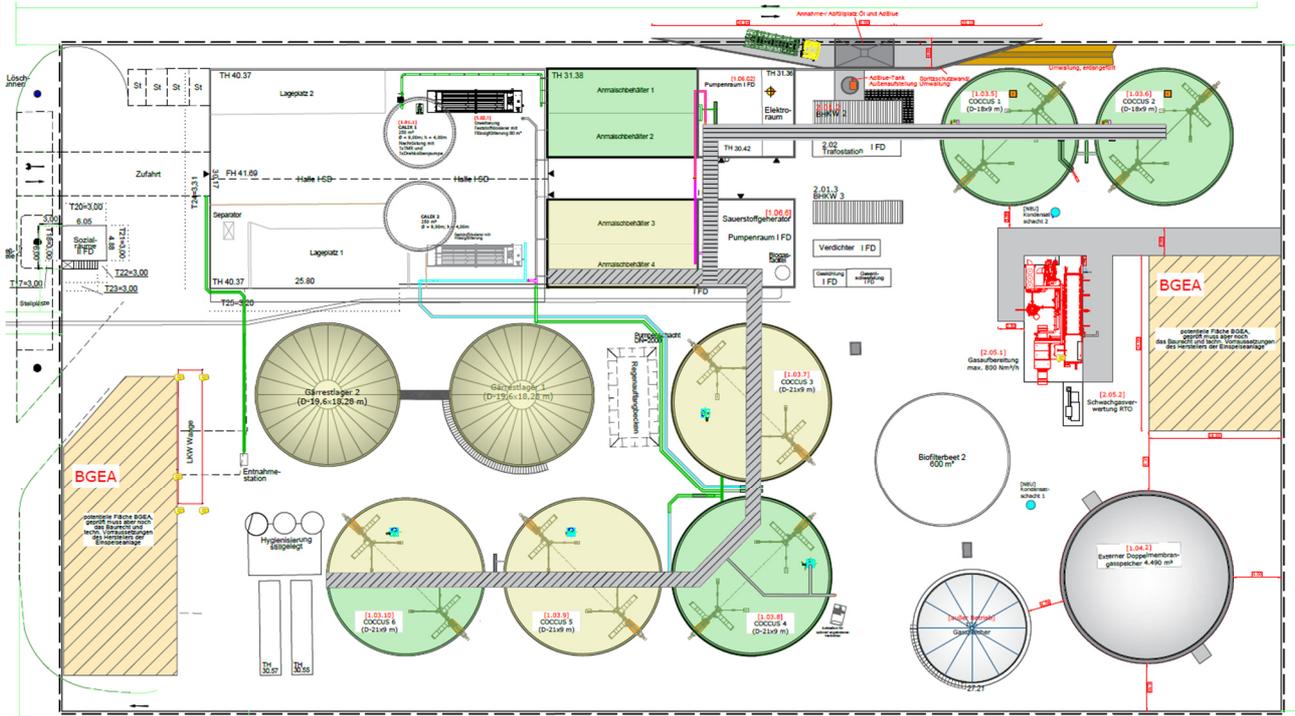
Lageplan BGA Hünxe nach Umbau Stand 26.06.2023.
